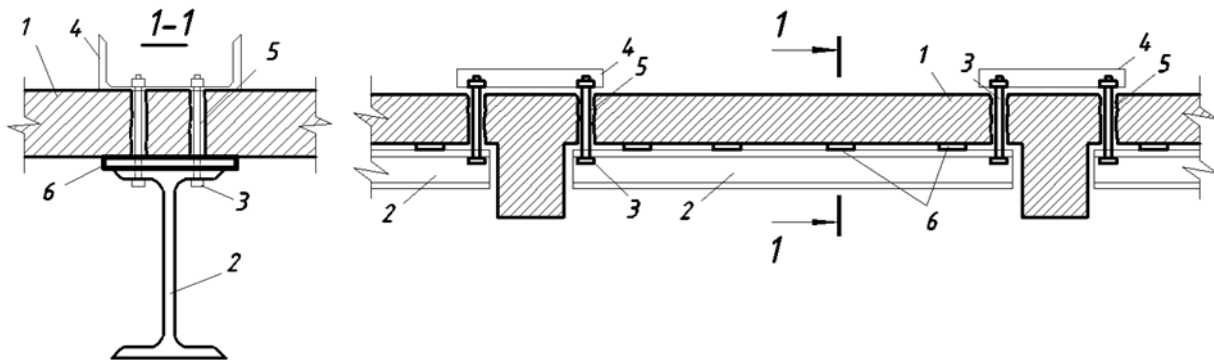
Підсилення монолітної залізобетонної плити:
